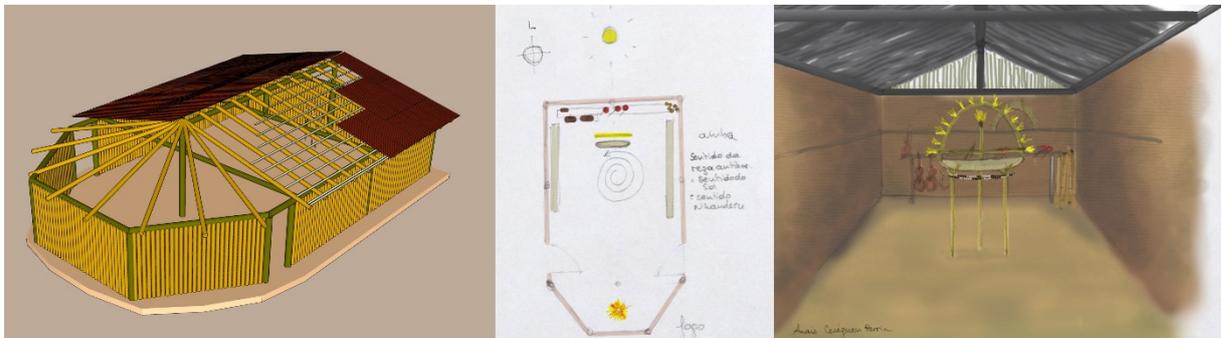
Opy da Yvy Porã; ilustração da planta com a parede oeste redonda e o *ambá
